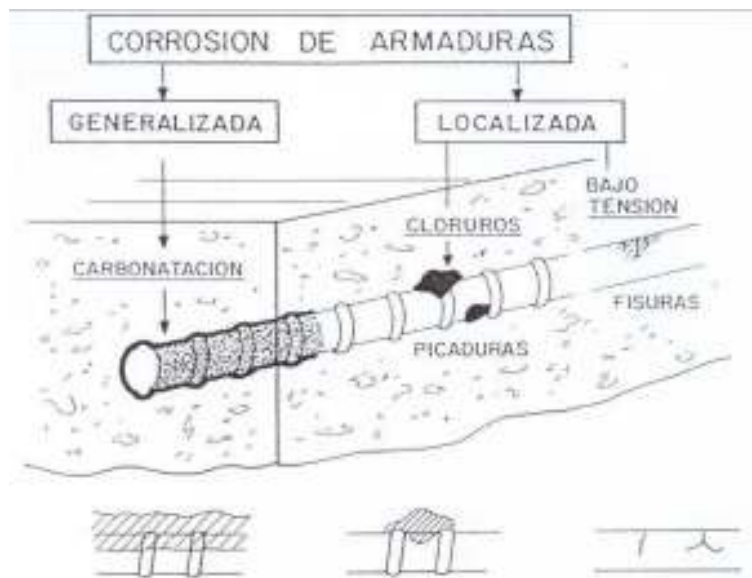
Tipos de corrosión de armaduras en el hormigón
